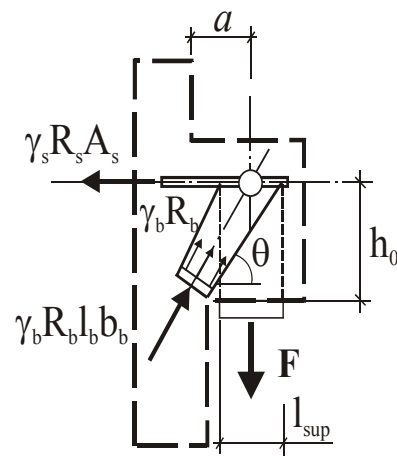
Схема предельных усилий в расчетных сжатых бетонных полосах и растянутом арматурном поясе:
